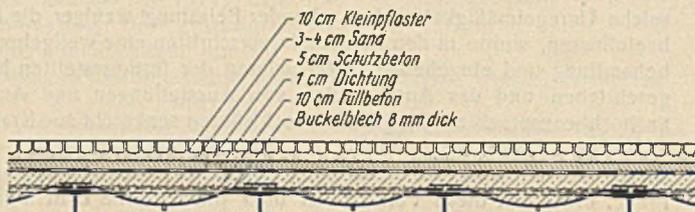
Schwere Fahrbahn mit Buckelblechen.
